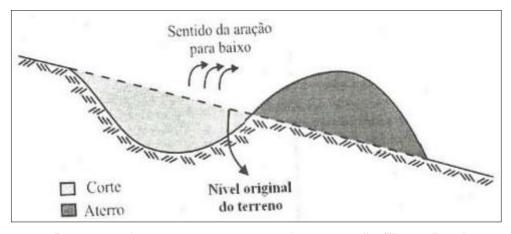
Demonstrativo quanto ao processo de construção (Fonte: Prusky, 2009).
